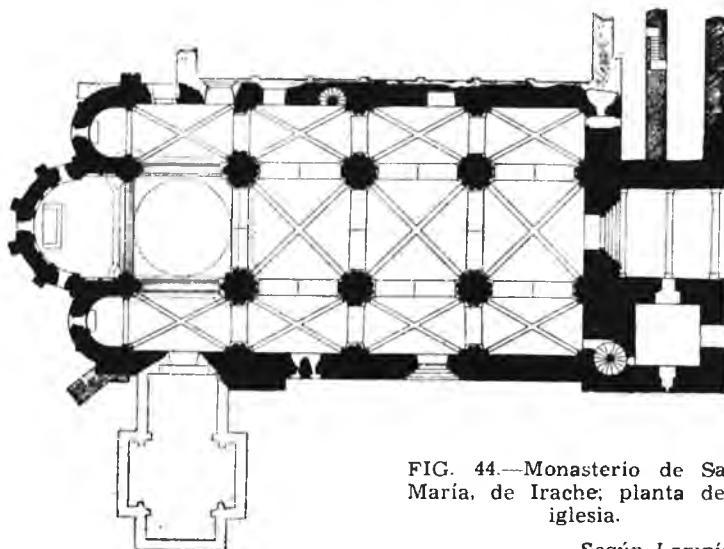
Monasterio de Santa María, de Irache; planta de la iglesia.
